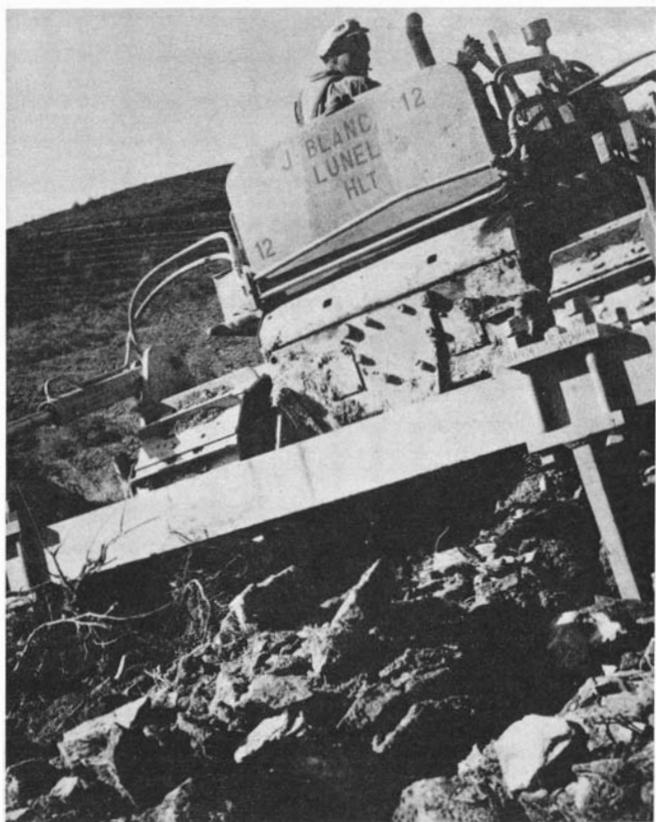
Travaux sur terrains en pente. 2. Sous-solage à deux dents de la banquette. Contrat F.F.N. de Bahours — S.C.I. du Gévaudan, 1962. Photo R. S.B.
